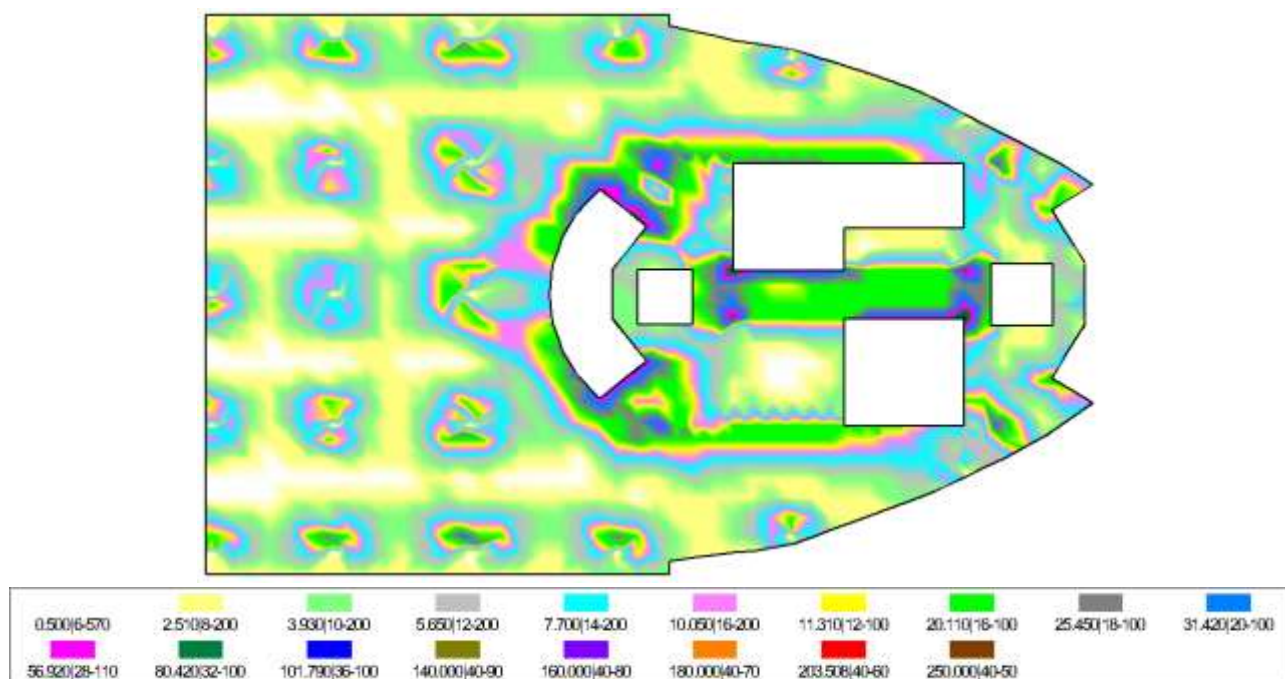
Армирование плиты перекрытия западной башни на отм. +42,80 м. Верхняя продольная арматура в направлении оси S, см²/м [15]
